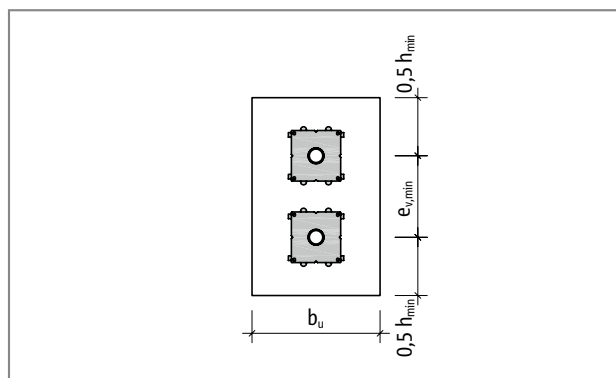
Schöck Dorn Typ SLD: Minimale Bauteilabmessungen und Dornabstände in der Stirnseite eines Balkens oder einer Wand
